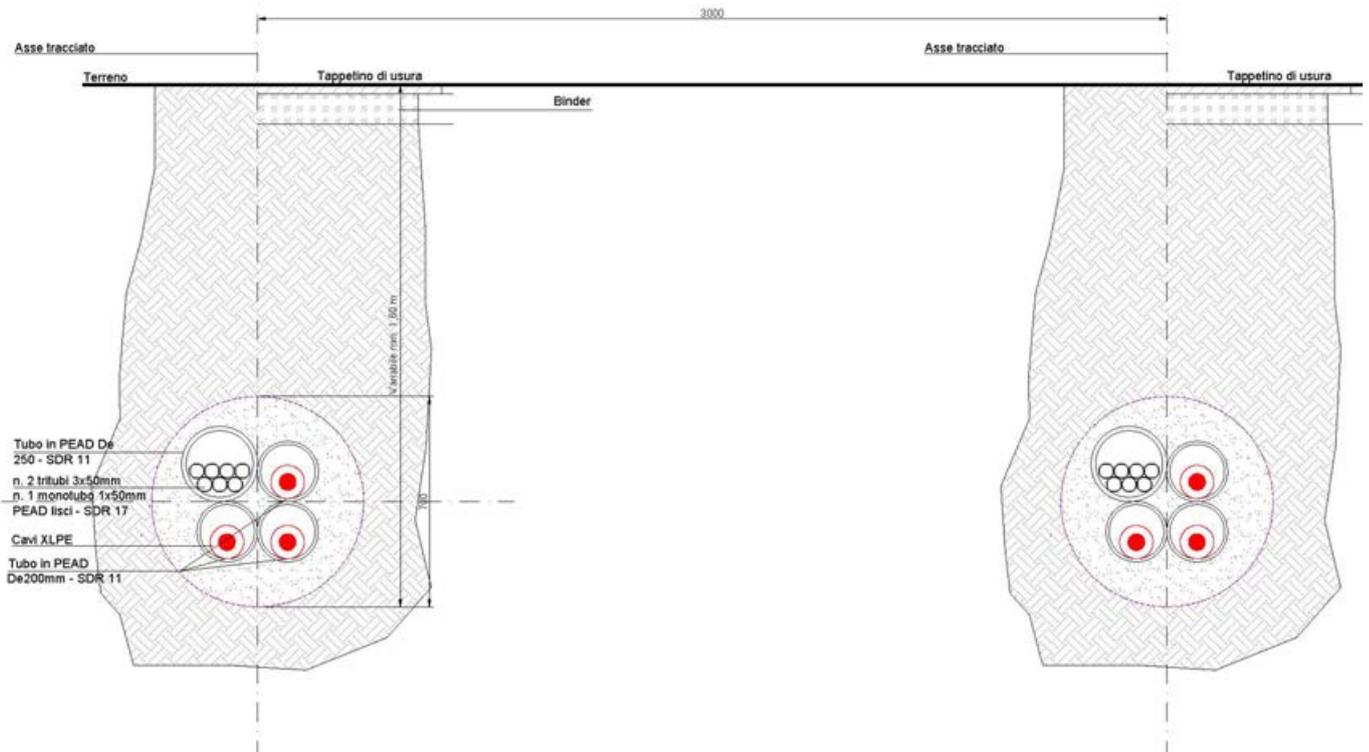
Sezione tipo di posa doppia terna T1
